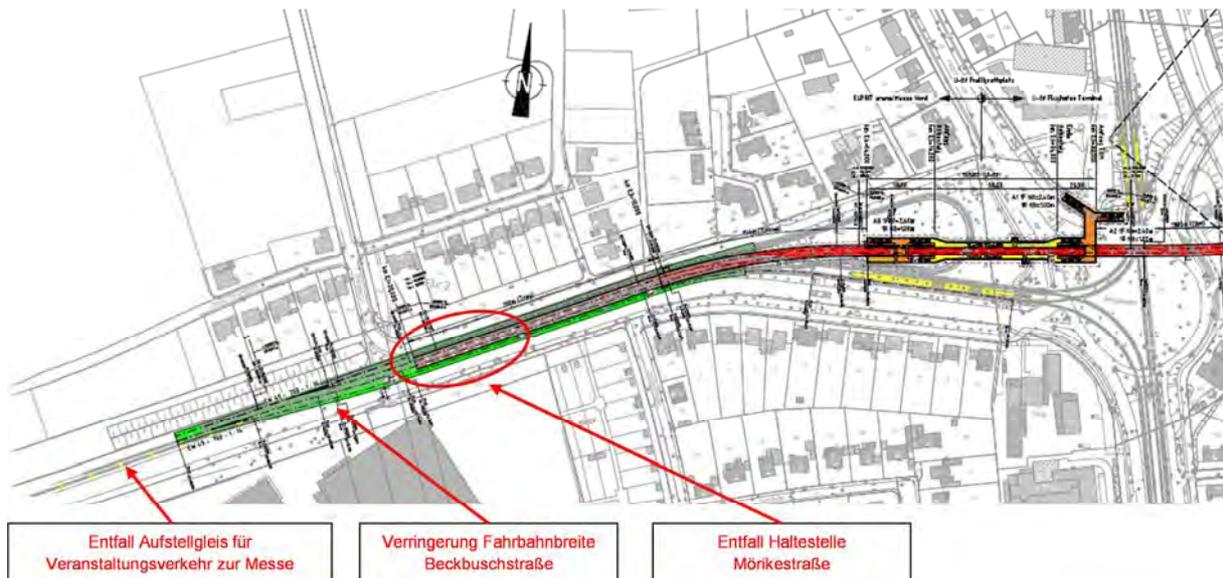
Tunnel Heimat und Bürgerverein, Lageplan Umsteigebahnhof Freiligrathplatz
